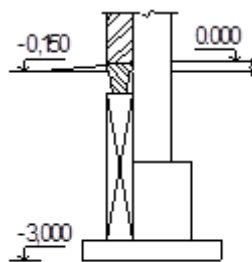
Конструкція фундаменту на перетині осей А і 5.
